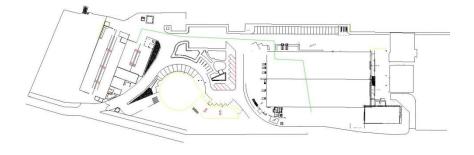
Recorrido de montacargas de bodega a planta
